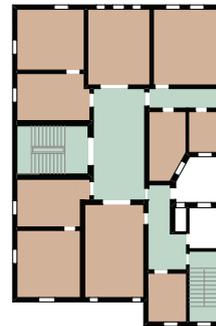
Raumaufteilung im Erdgeschoss der Villa
